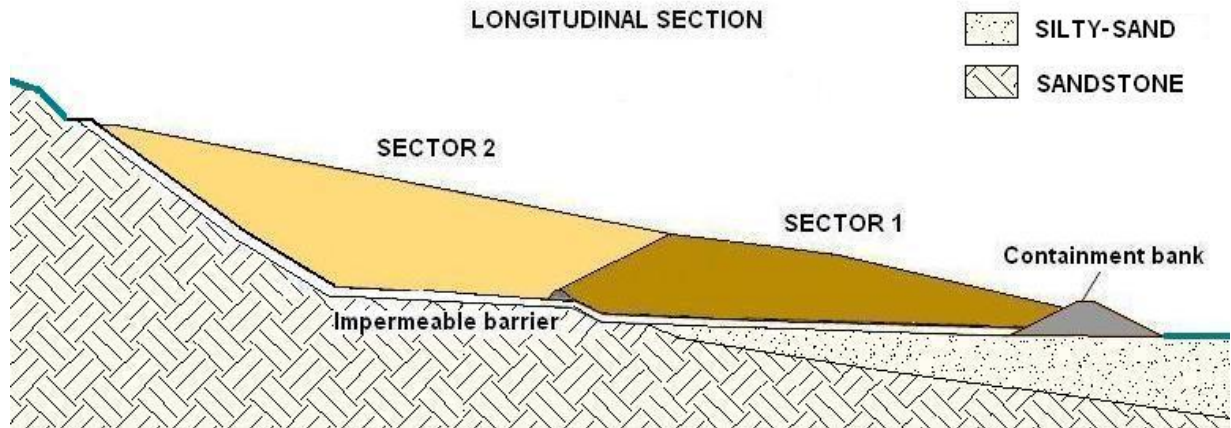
Sezione longitudinale della *Discarica B* raffigurante i settori 1 e 2.
